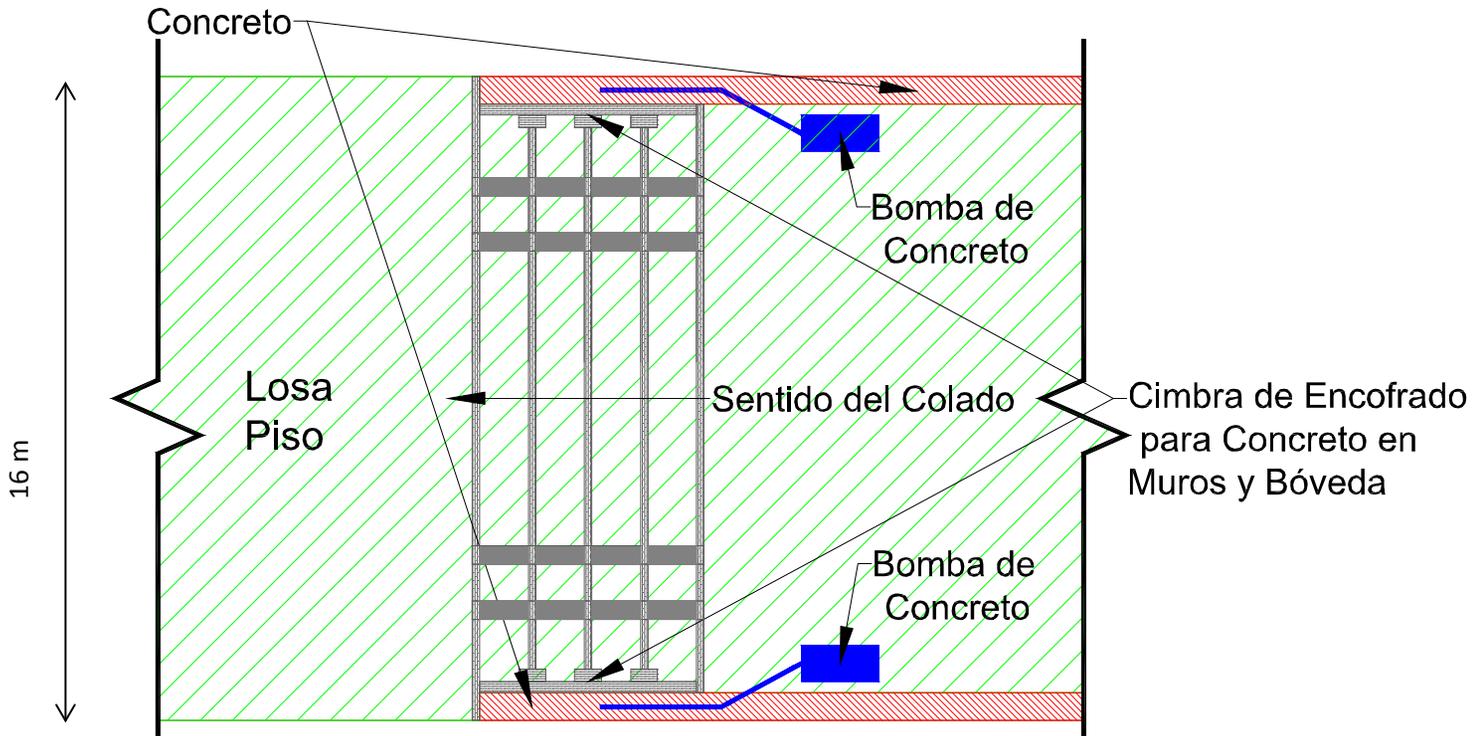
Esquema de colados a sección completa en Túnel visto en planta
